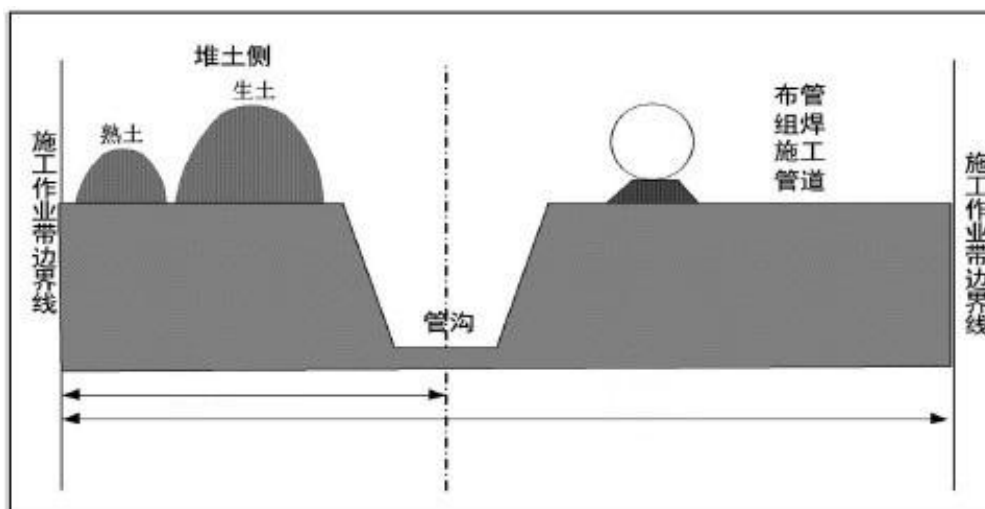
一般地段管线施工方式断面示意图（开挖）
